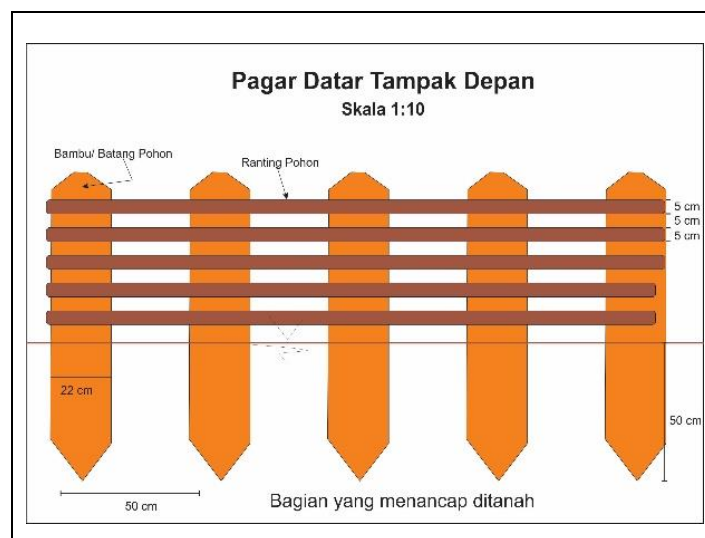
Sketsa Penanaman Tebing, Tampak depan
